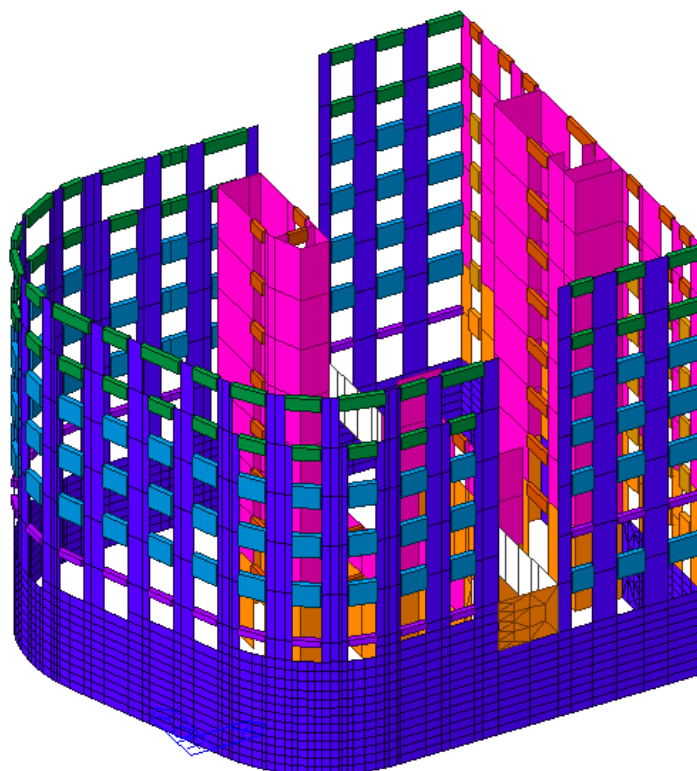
Vista 3D del modello di calcolo per i setti in c.a. - vista dei soli "wall" e delle travi di collegamento
